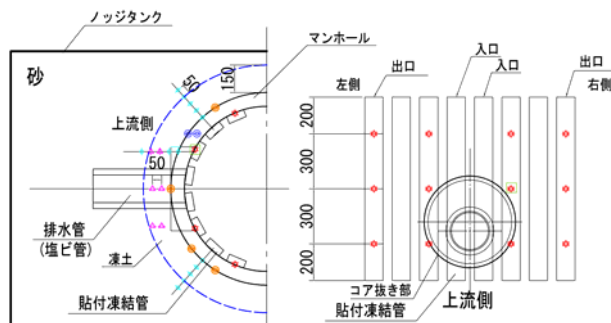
温度計配置図(左:平面図, 右:側面展開図)
